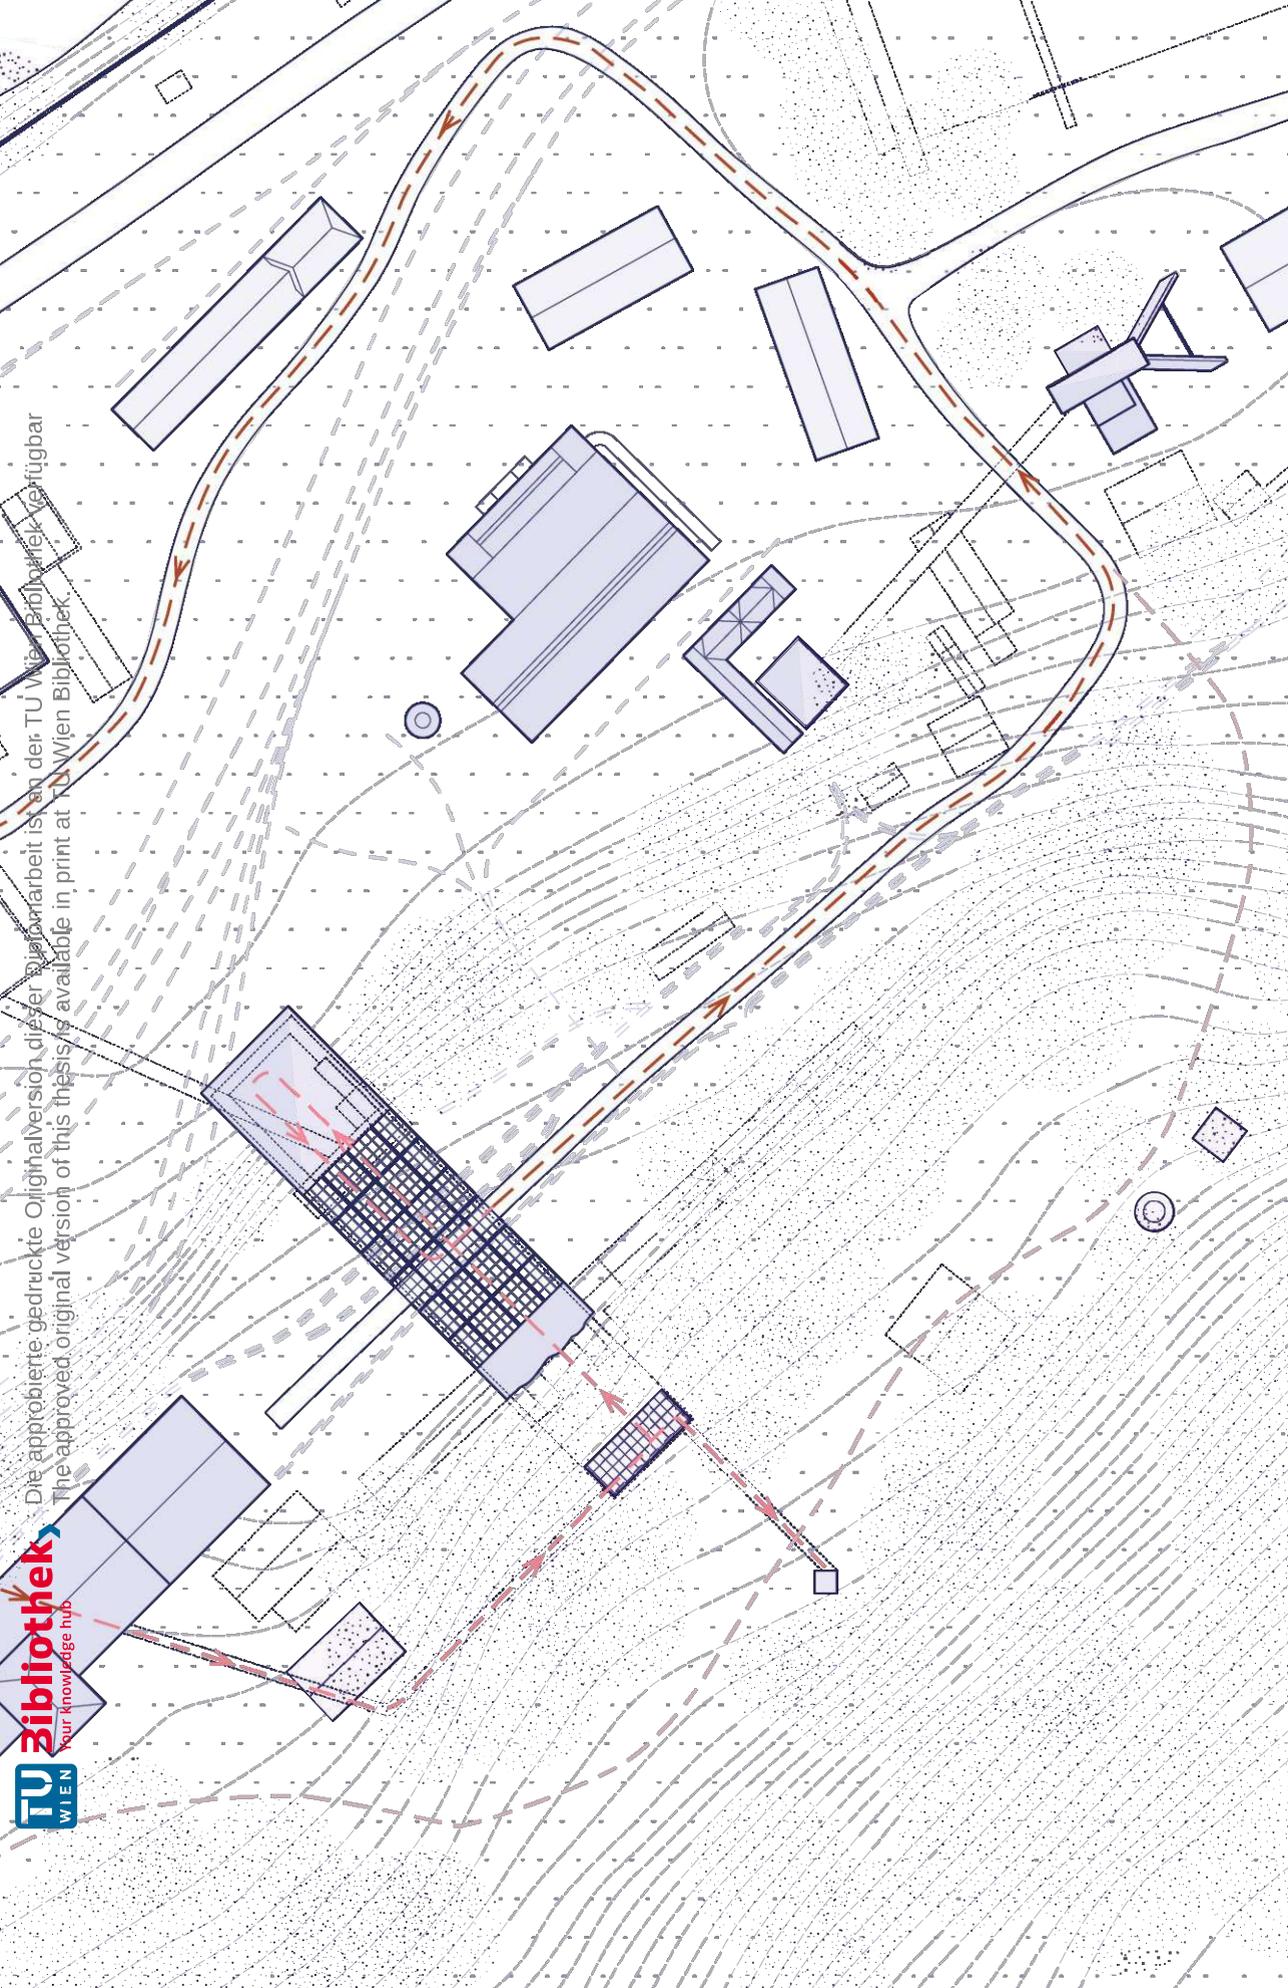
Lageplan, 1:1500, Verlauf der Bewegung durch das Areal
